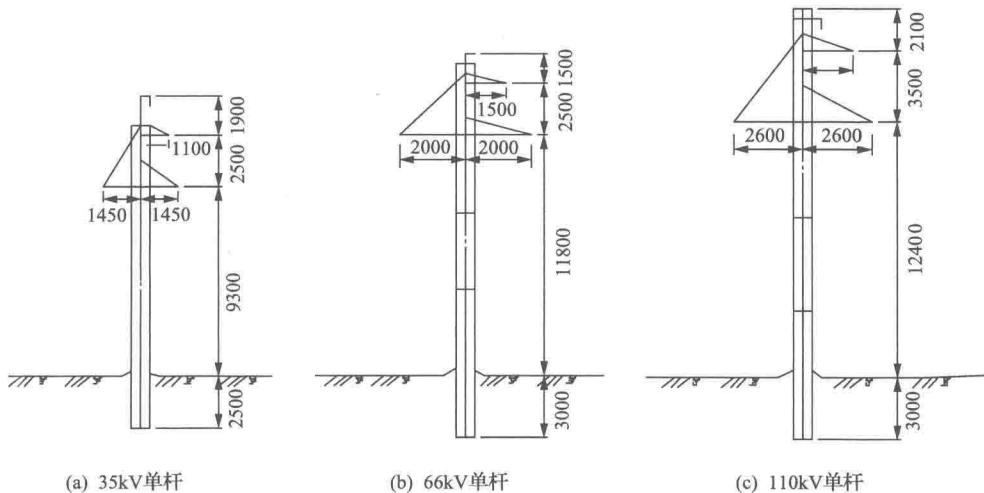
35~110kV钢筋混凝土悬垂直线单杆(单位:mm)
